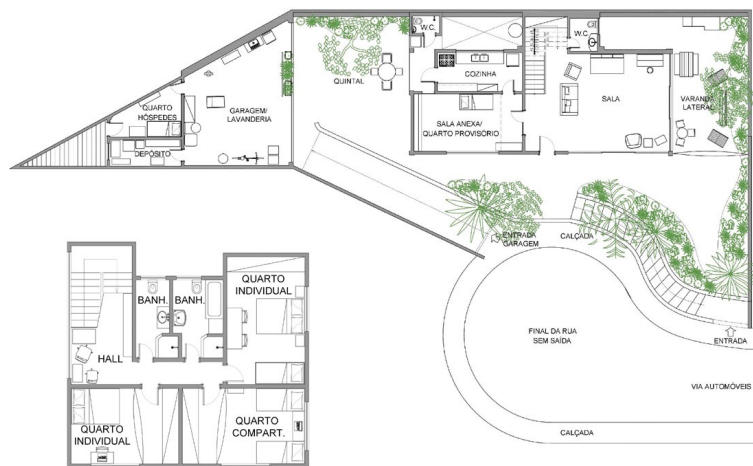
Planta da Casa Ânima com o detalhe, à esquerda, do pavimento superior. Fonte: Autora(2018).
